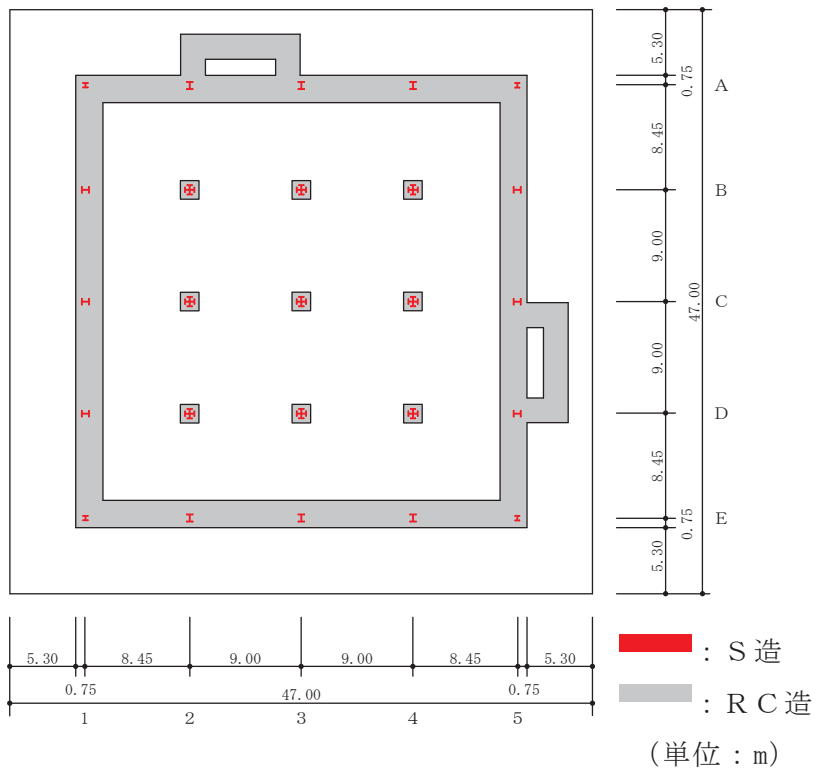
(1) 緊急時対策建屋の概略平面図 (O.P. 51.5m)
